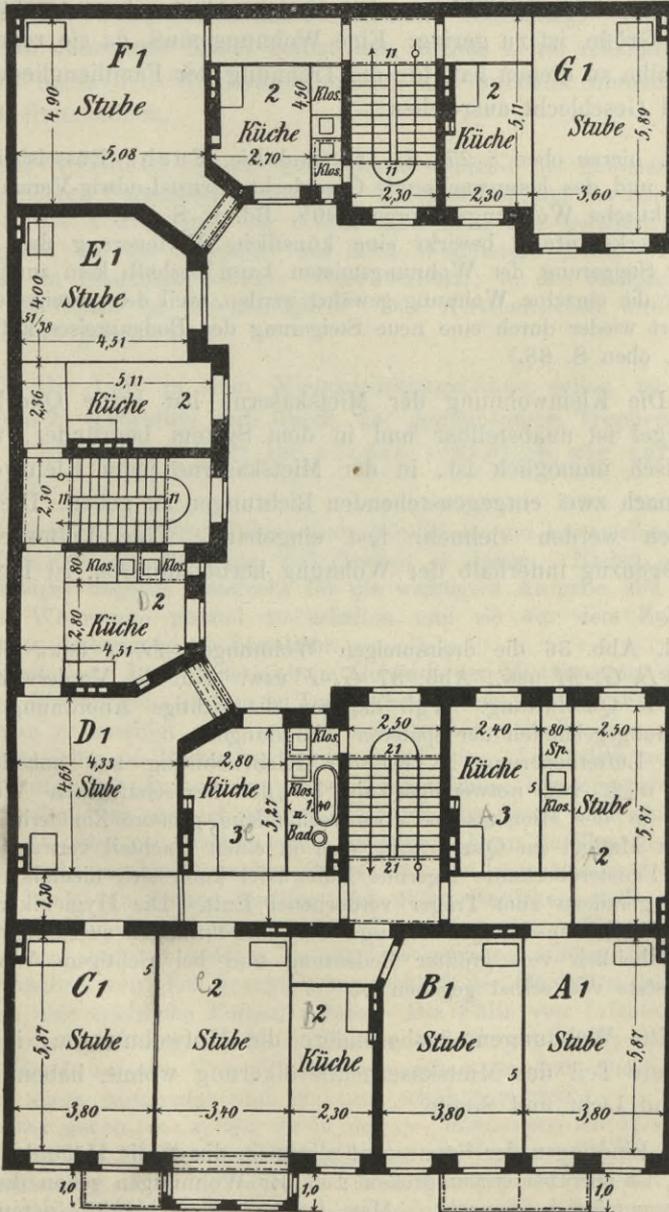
Berliner Mietskasernen mit einfachem Quergebäude. Baujahr 1904. Maßstab 1:200.
